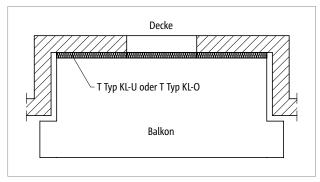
Schöck Isokorb® T Typ KL-U/KL-O: Balkon bei Fassadenrücksprung
